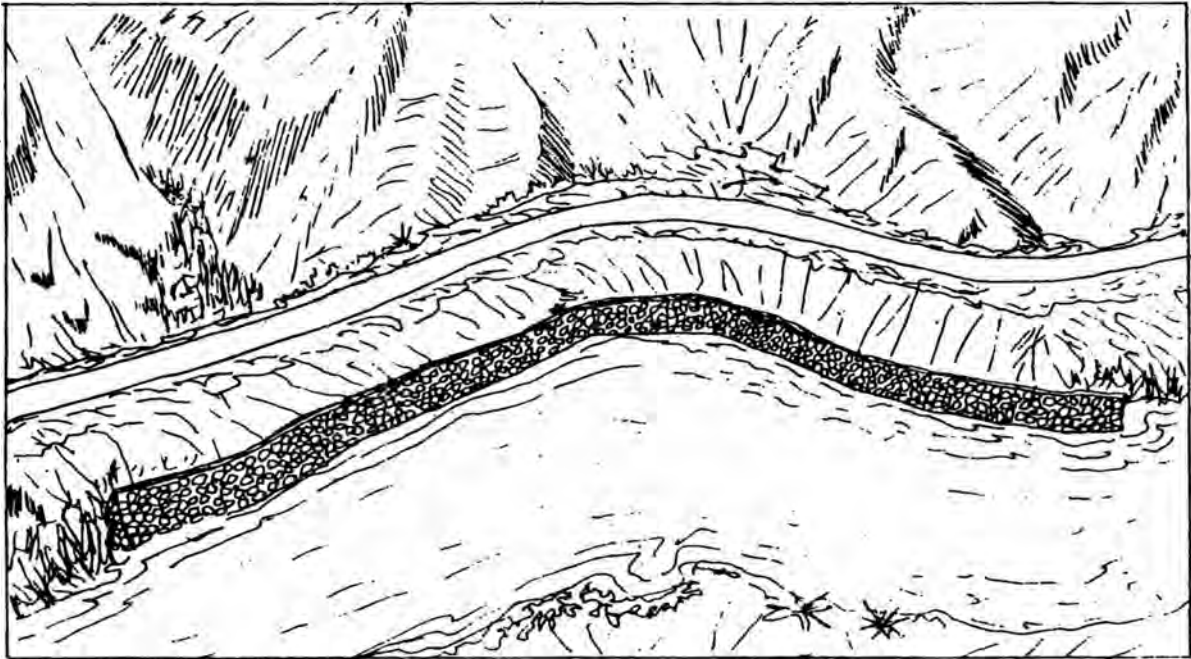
Protección del toled inferior de lo vía con un muro de mamposteria de al-boñileria.
